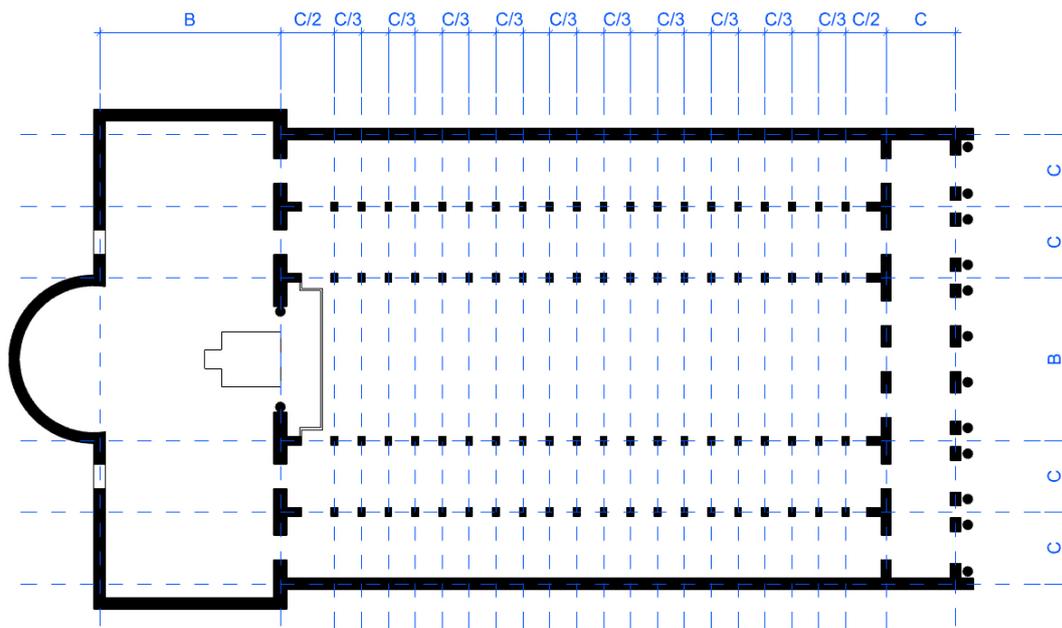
Abstandsproportionen im Grundriss in St. Paul
